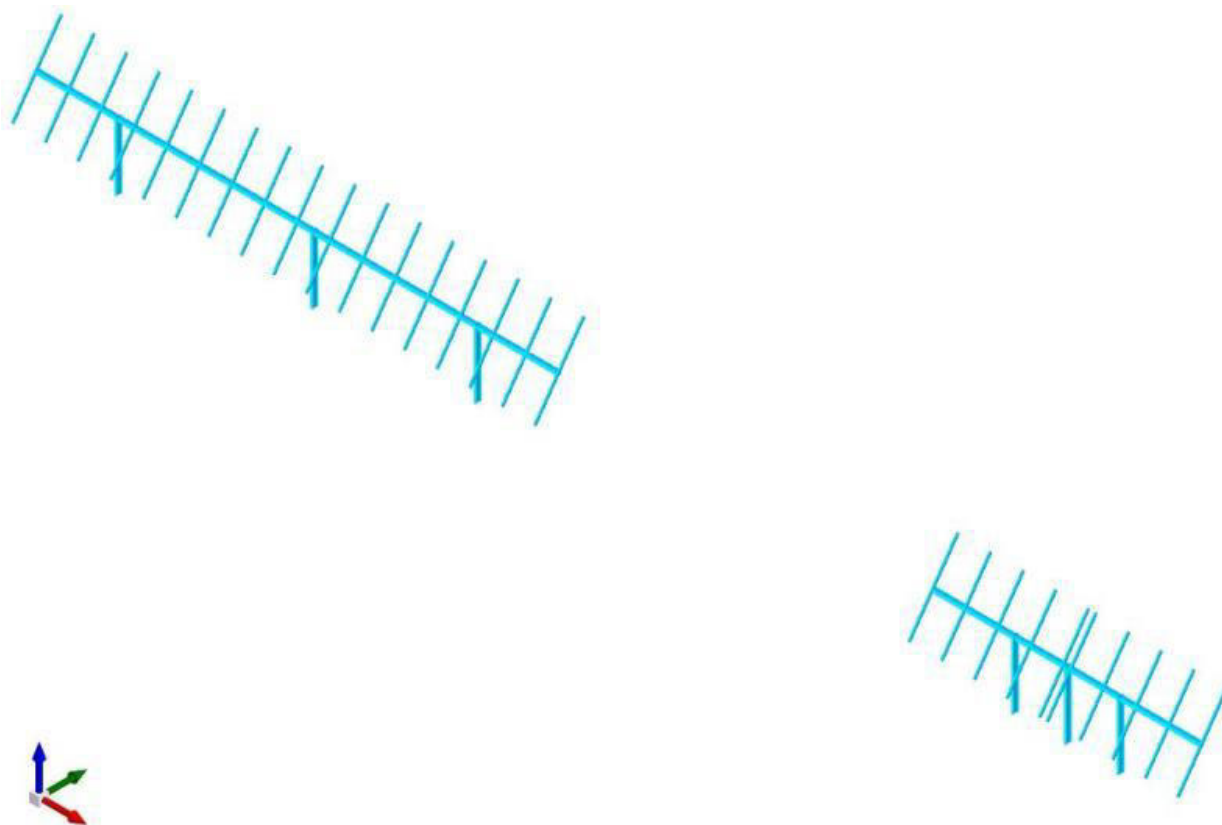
Vista assonometrica modello strutturale con posizione della “vela” inclinata di 60°
